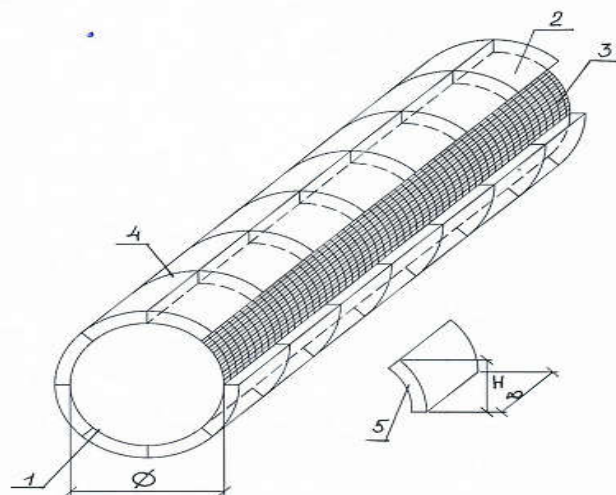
Схема теплоизоляции труб инженерных сооружений теплоизоляционными плитами сегментами из пеностеклобетона
